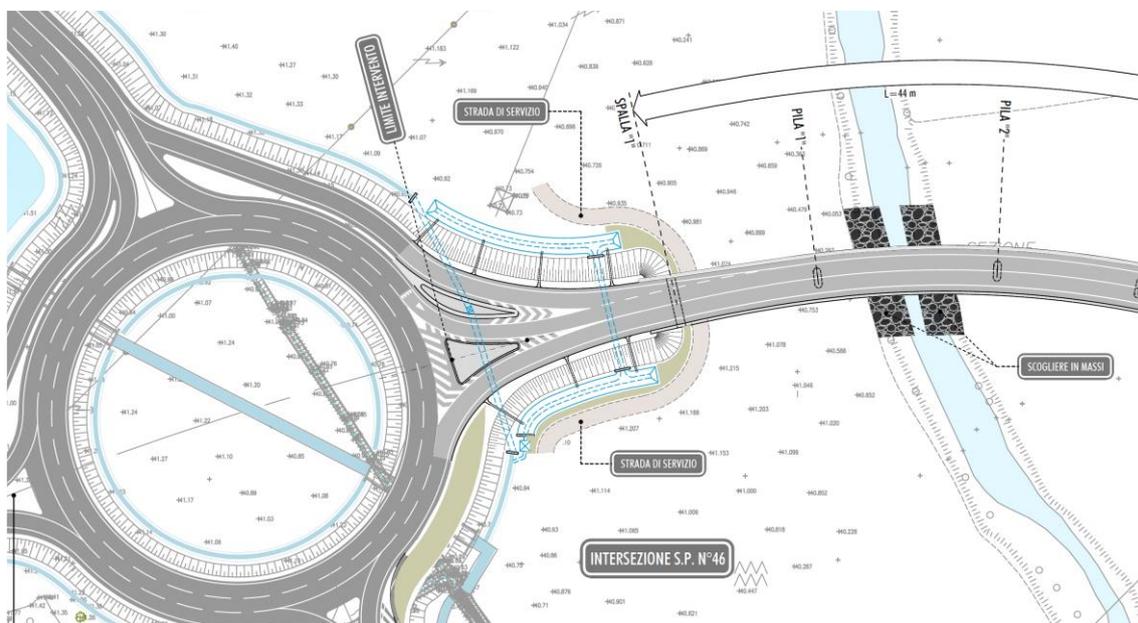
Completamento S.P. n° 46 – stralcio planimetrico
